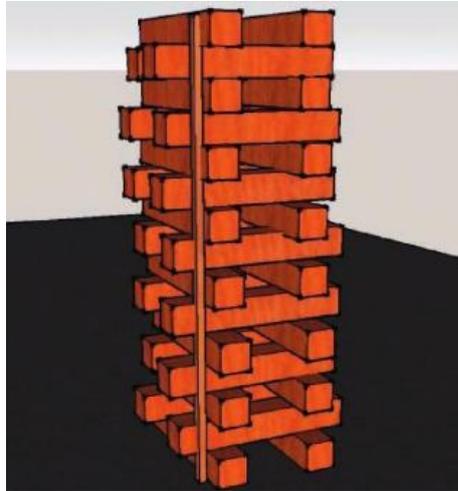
Zappeado alto con listón en lateral para facilitar colocación y avisar de descuadres.
